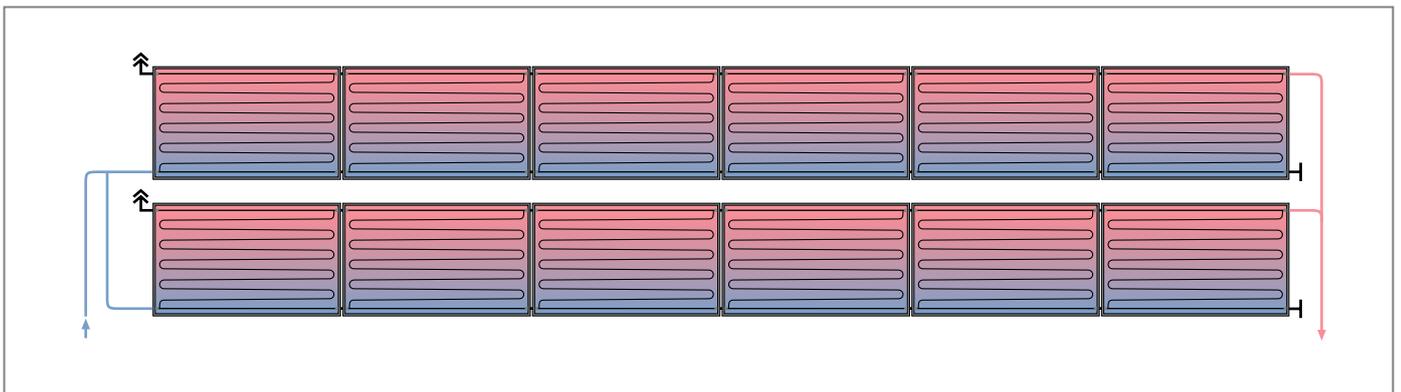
Schema dei collegamenti con 12 collettori collegati su due file in modo alternato
